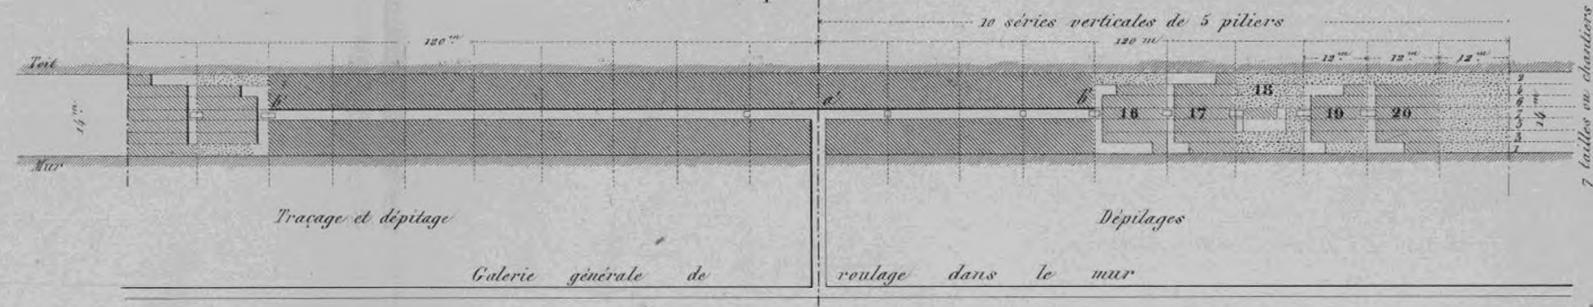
Coupe horizontale d'un pilier en exploitation.
